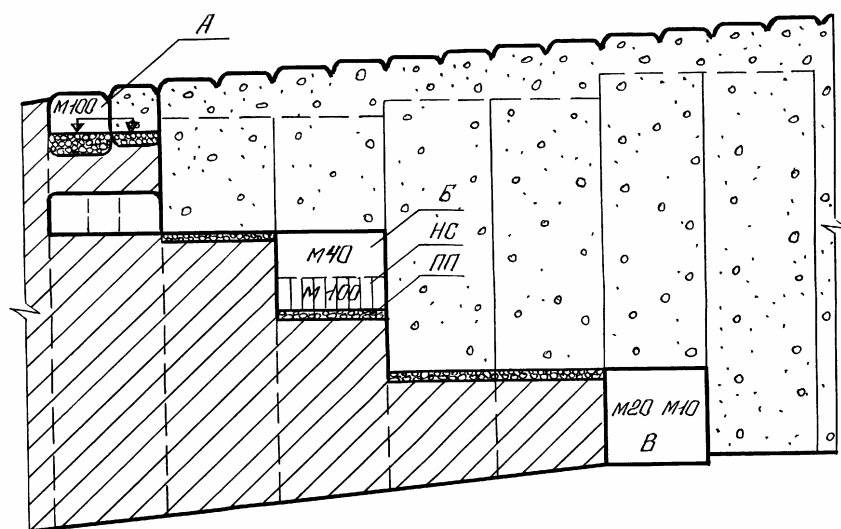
Формирование закладочного массива при нисходящем порядке выемки: А – секционное возведение искусственной кровли в выработках защитного перекрытия; Б – закладка основных слоев; В – погашение пустот последнего слоя в ленте; НС – несущий слой; ПП – предохранительная подсыпка;
